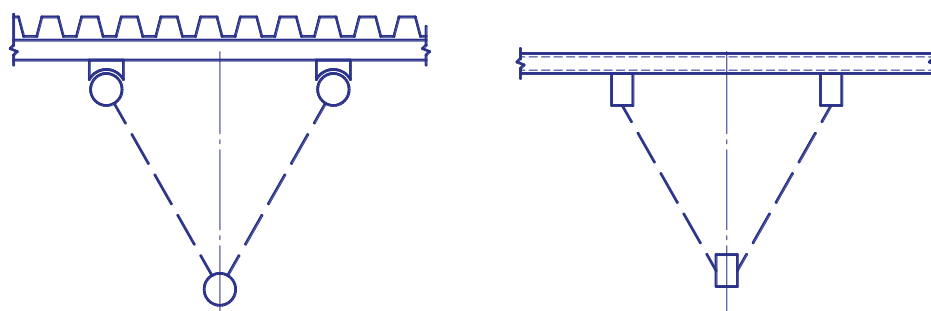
Сечения трёхгранных ферм из круглых труб с прогонной кровлей и из прямоугольных труб с беспрогонной кровлей
